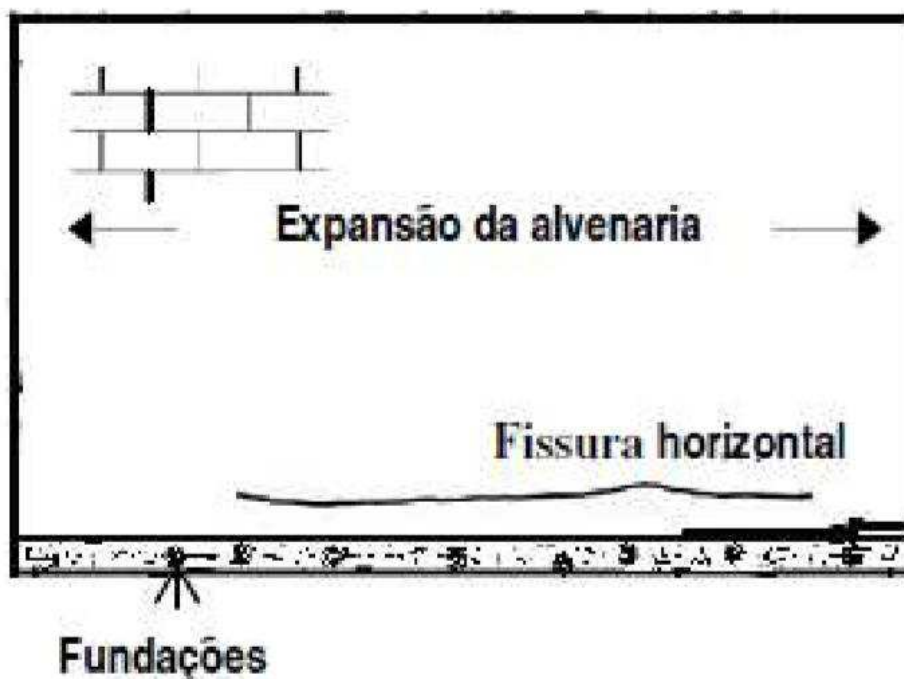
Fissuras horizontais provocadas por expansão vertical.
